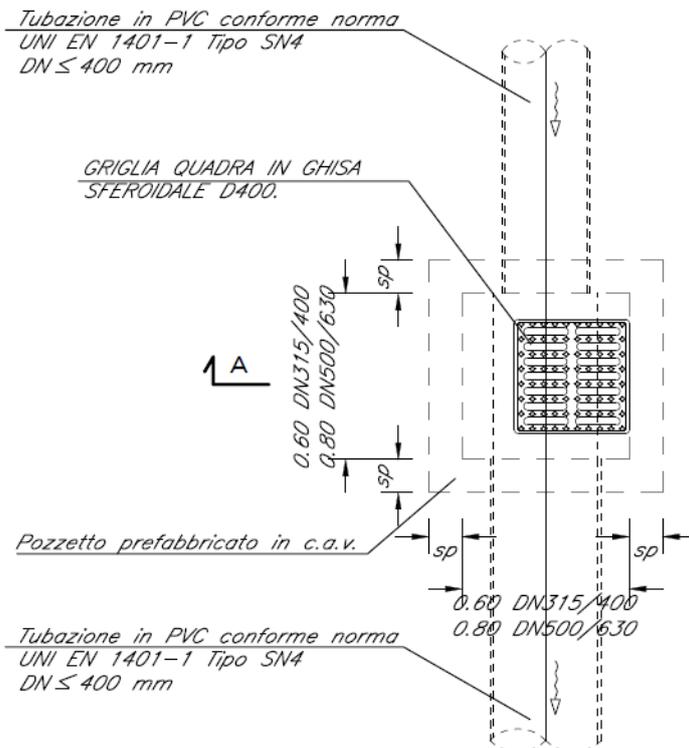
Drenaggio stradale – Pianta pozzetto grigliato
